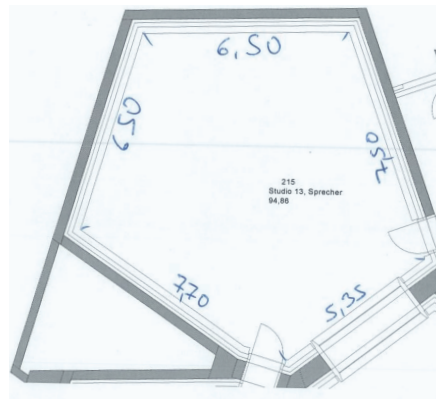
Grundriss Studio 13, SWR Stuttgart.¹³⁹
